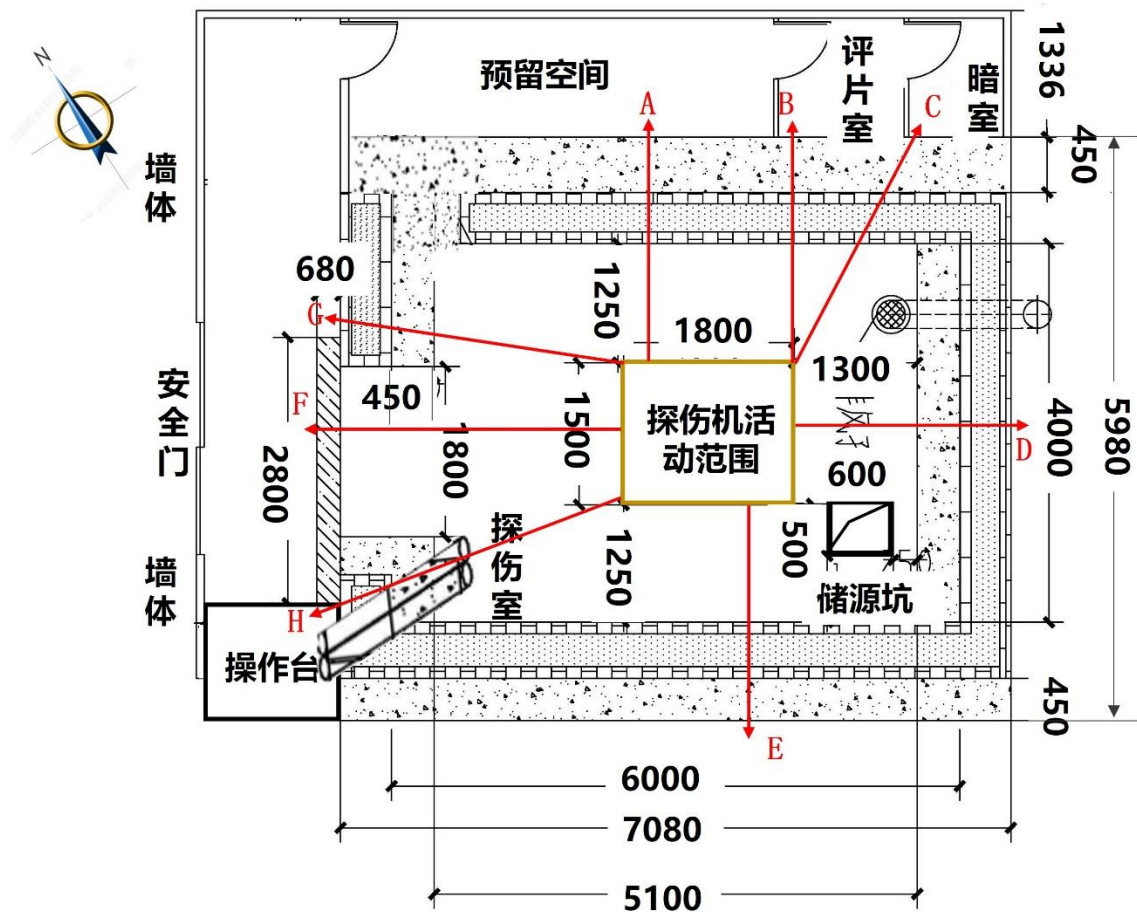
探伤室平面布局预测点位示意图 单位 (mm)
